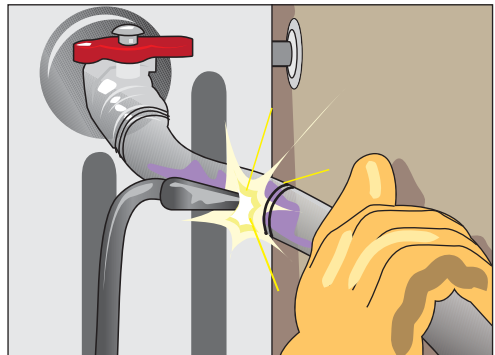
Для сваривания труб используем метод газовой сварки
